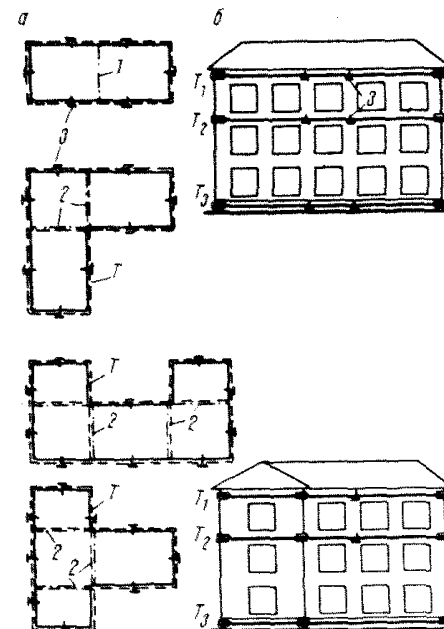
Схема устройства тяжей без разрезки здания на отсеки
